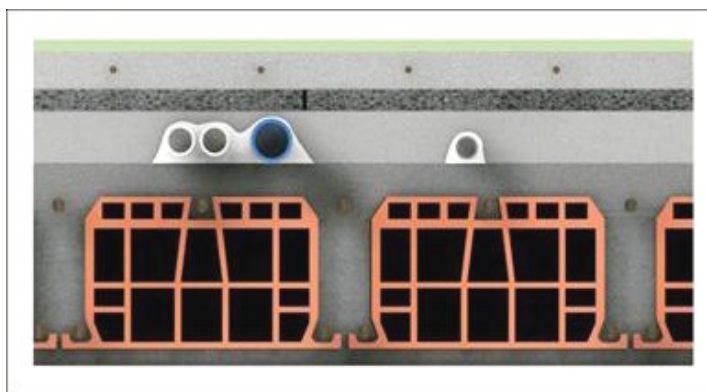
Posizionamento delle tubazioni impiantistiche al di sotto del sistema galleggiante
